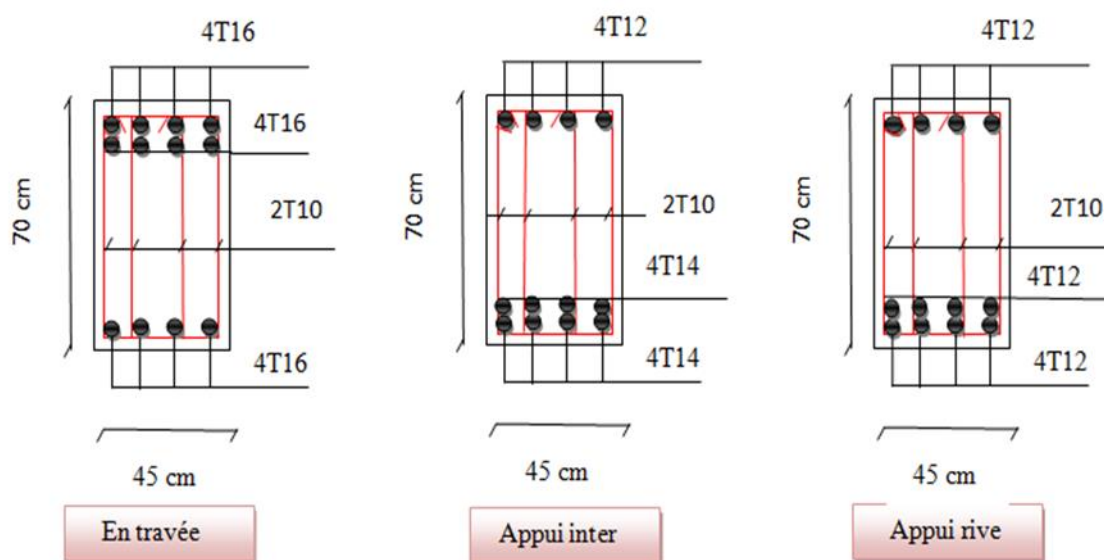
Ferrailage de la poutre de libage suivant le sens transversale.
